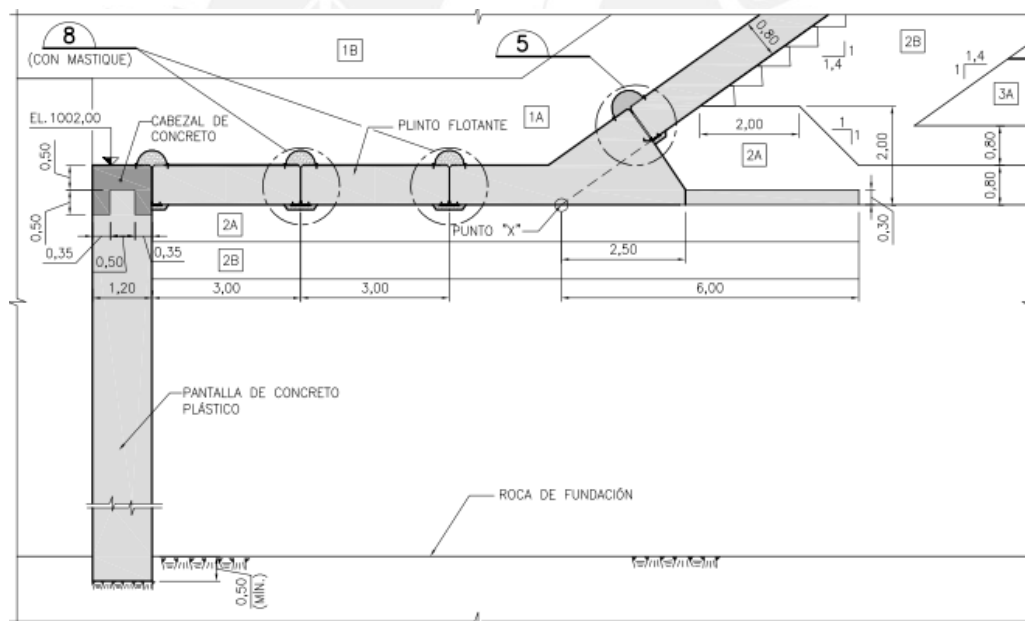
Corte Transversal del plinto flotante – Proyecto Base
